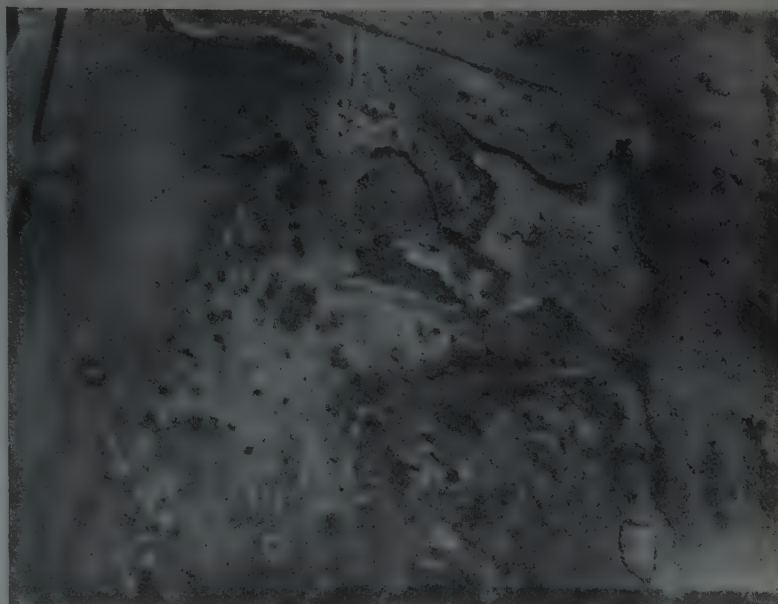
Angoulême. Mur d'une maison, face sud : éclatement de la surface de parement.
